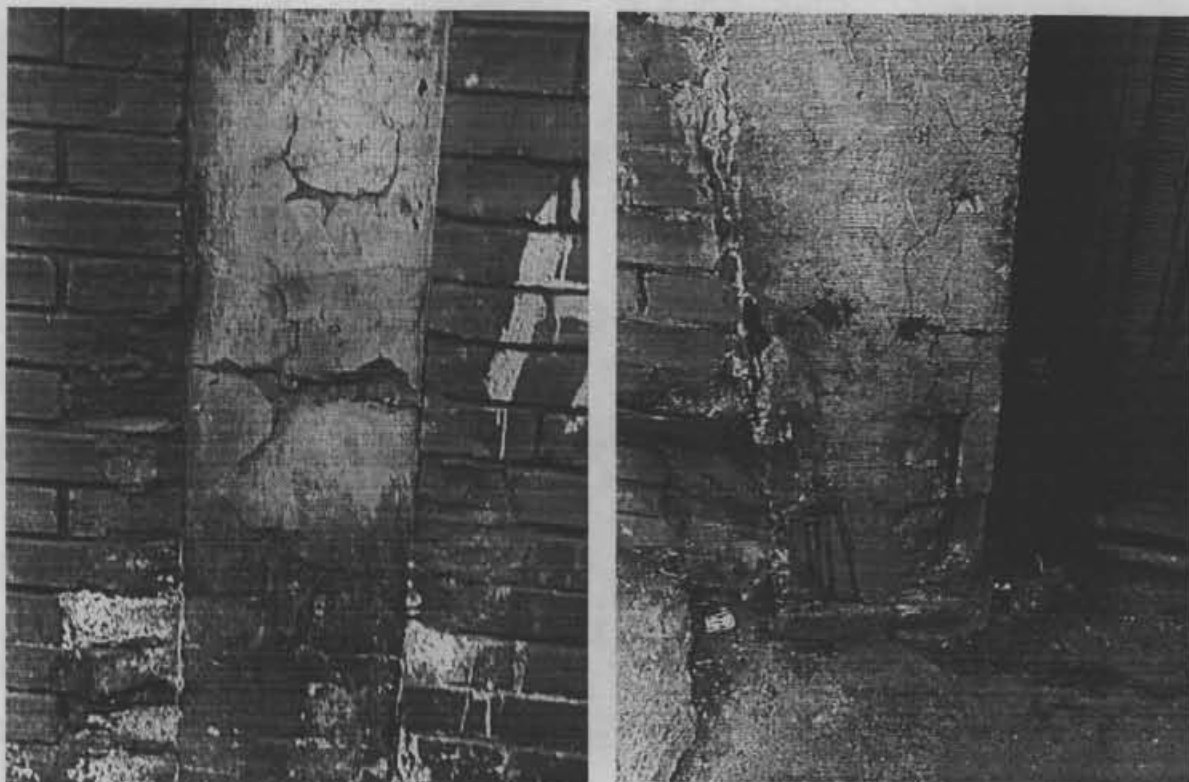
Detalle de la deficiencia constructiva. La columna se construyó por secciones, cuando debió haber sido monolítica.
